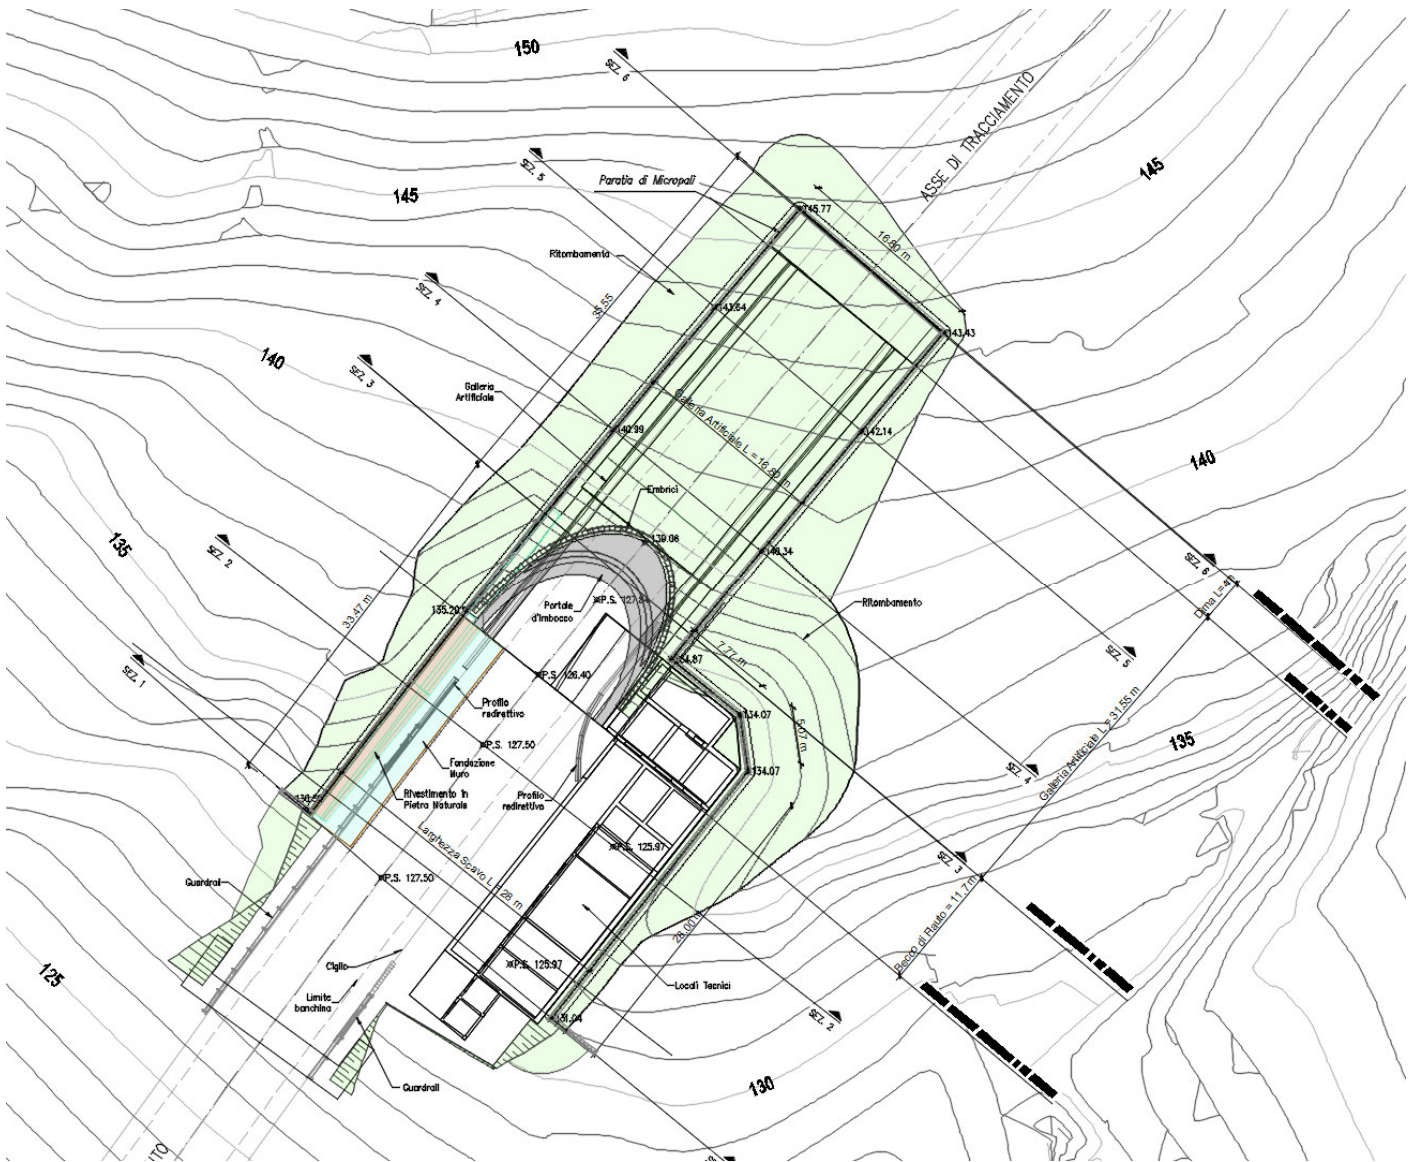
Planimetria tratta artificiale – Galleria Montebonello - Imbocco Sud
